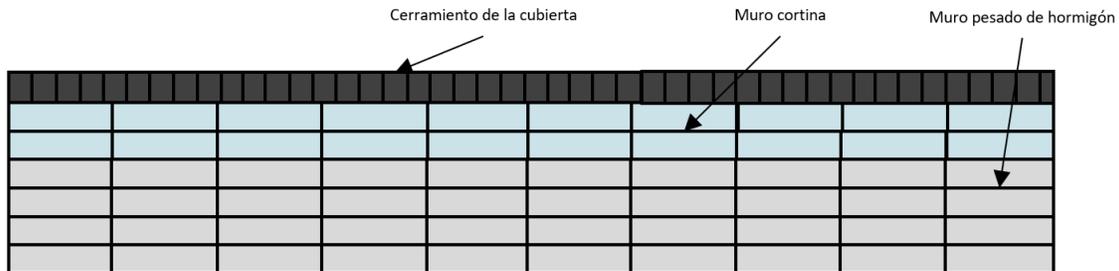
Esquema de los cerramientos de la fachada lateral. Elaboración propia.
